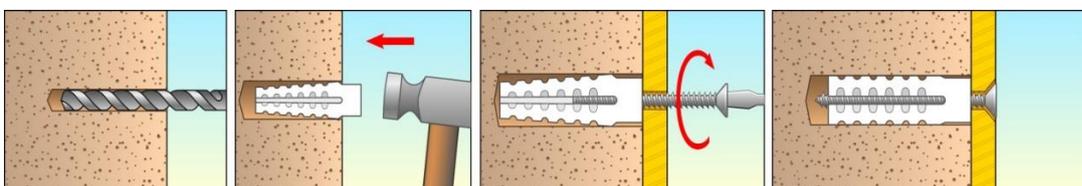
Схематичная установка дюбеля с саморезом
